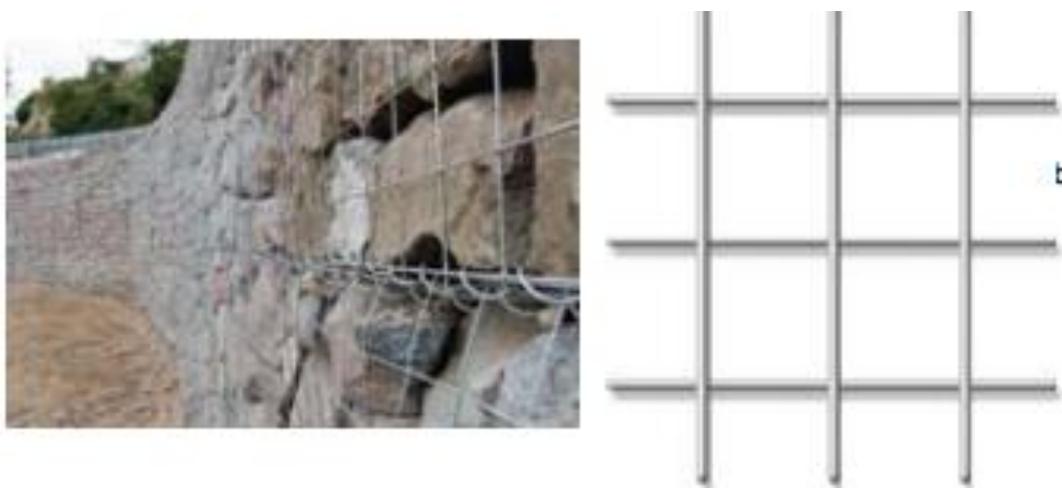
Muro de gaviones malla electrosoldada
